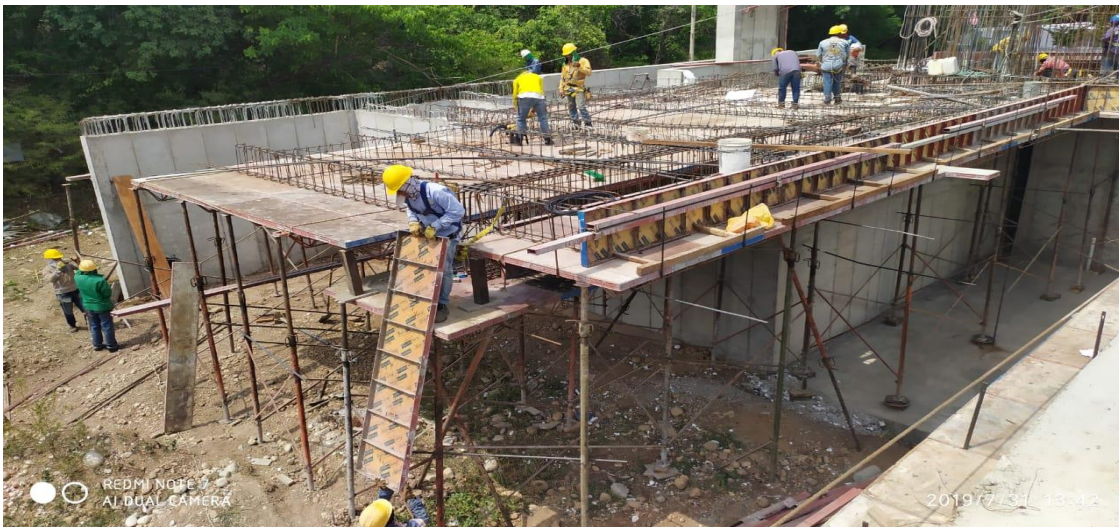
Armado de Vigas Para Placa N+3,40 Sin Torta Inferior
